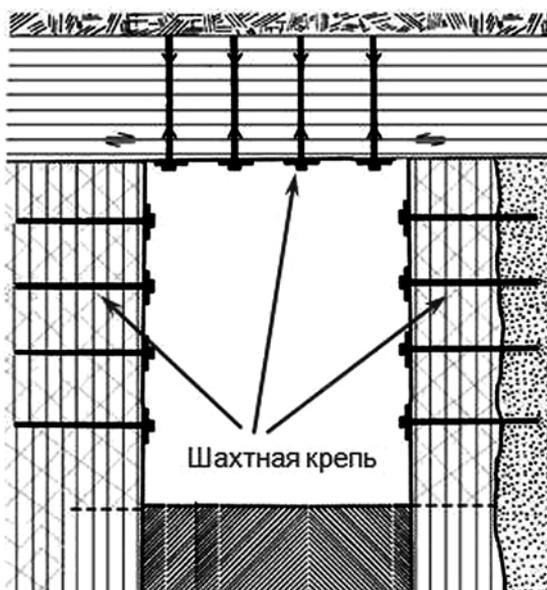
Схема установки анкерной крепи в кровлю и бока горной выработки
